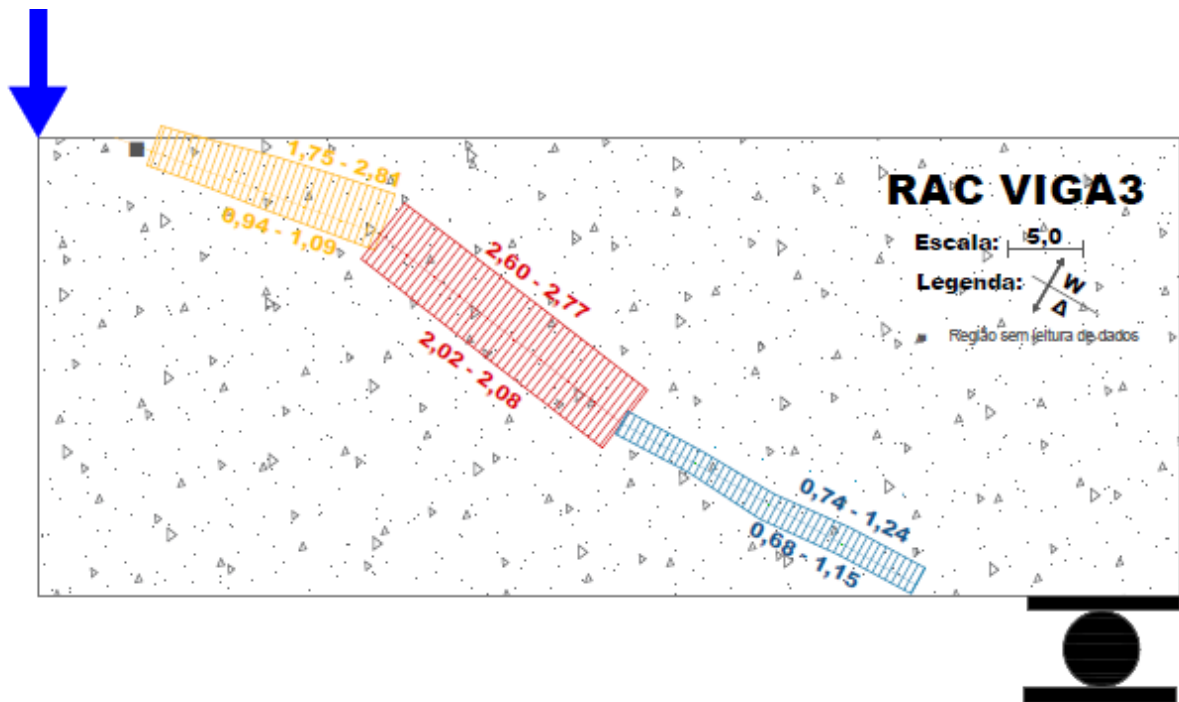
Abertura (w) e deslizamento (Δ) da fissura diagonal crítica da viga RAC-3.
